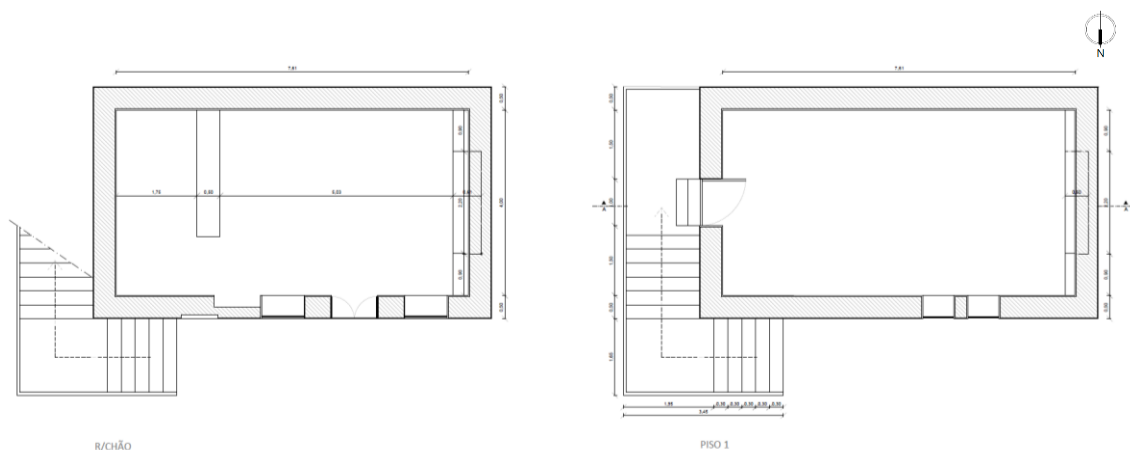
Plantas de Levantamento, Rés do Chão e Piso 1 da Casa em anexo.
